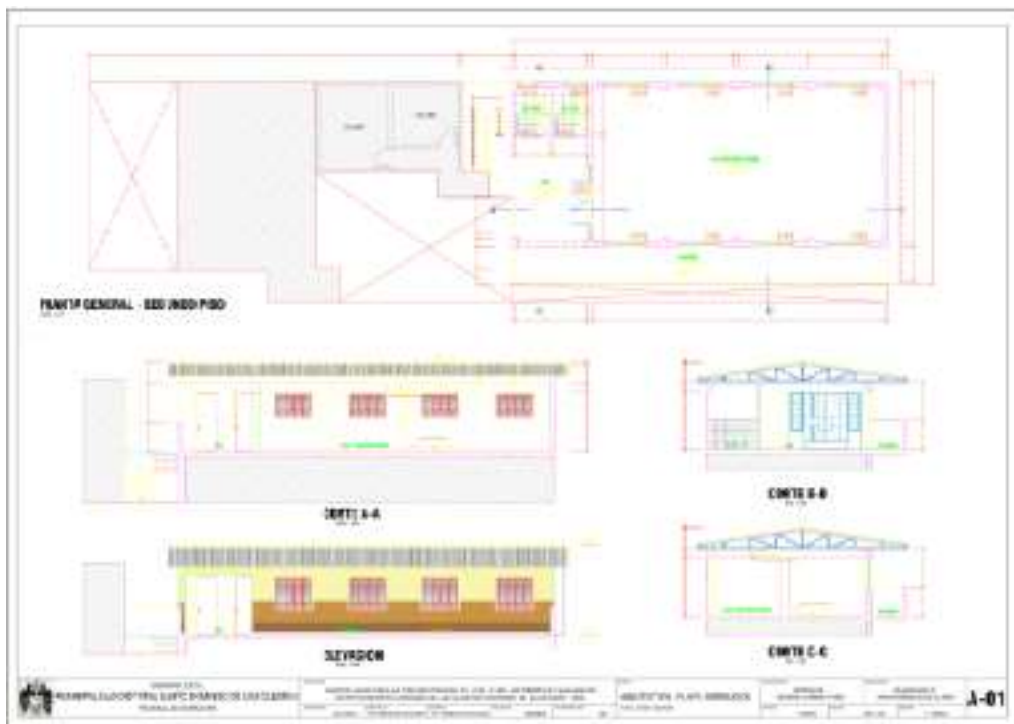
Plano de Arquitectura (Fuente: Elaboración propia)
